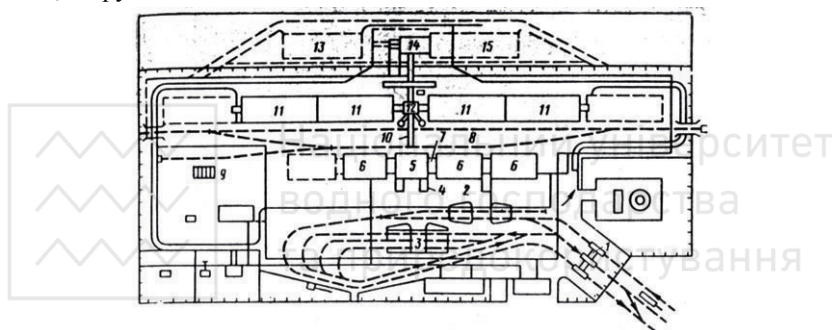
Приёмный пункт и заготовительные склады для зерна:
